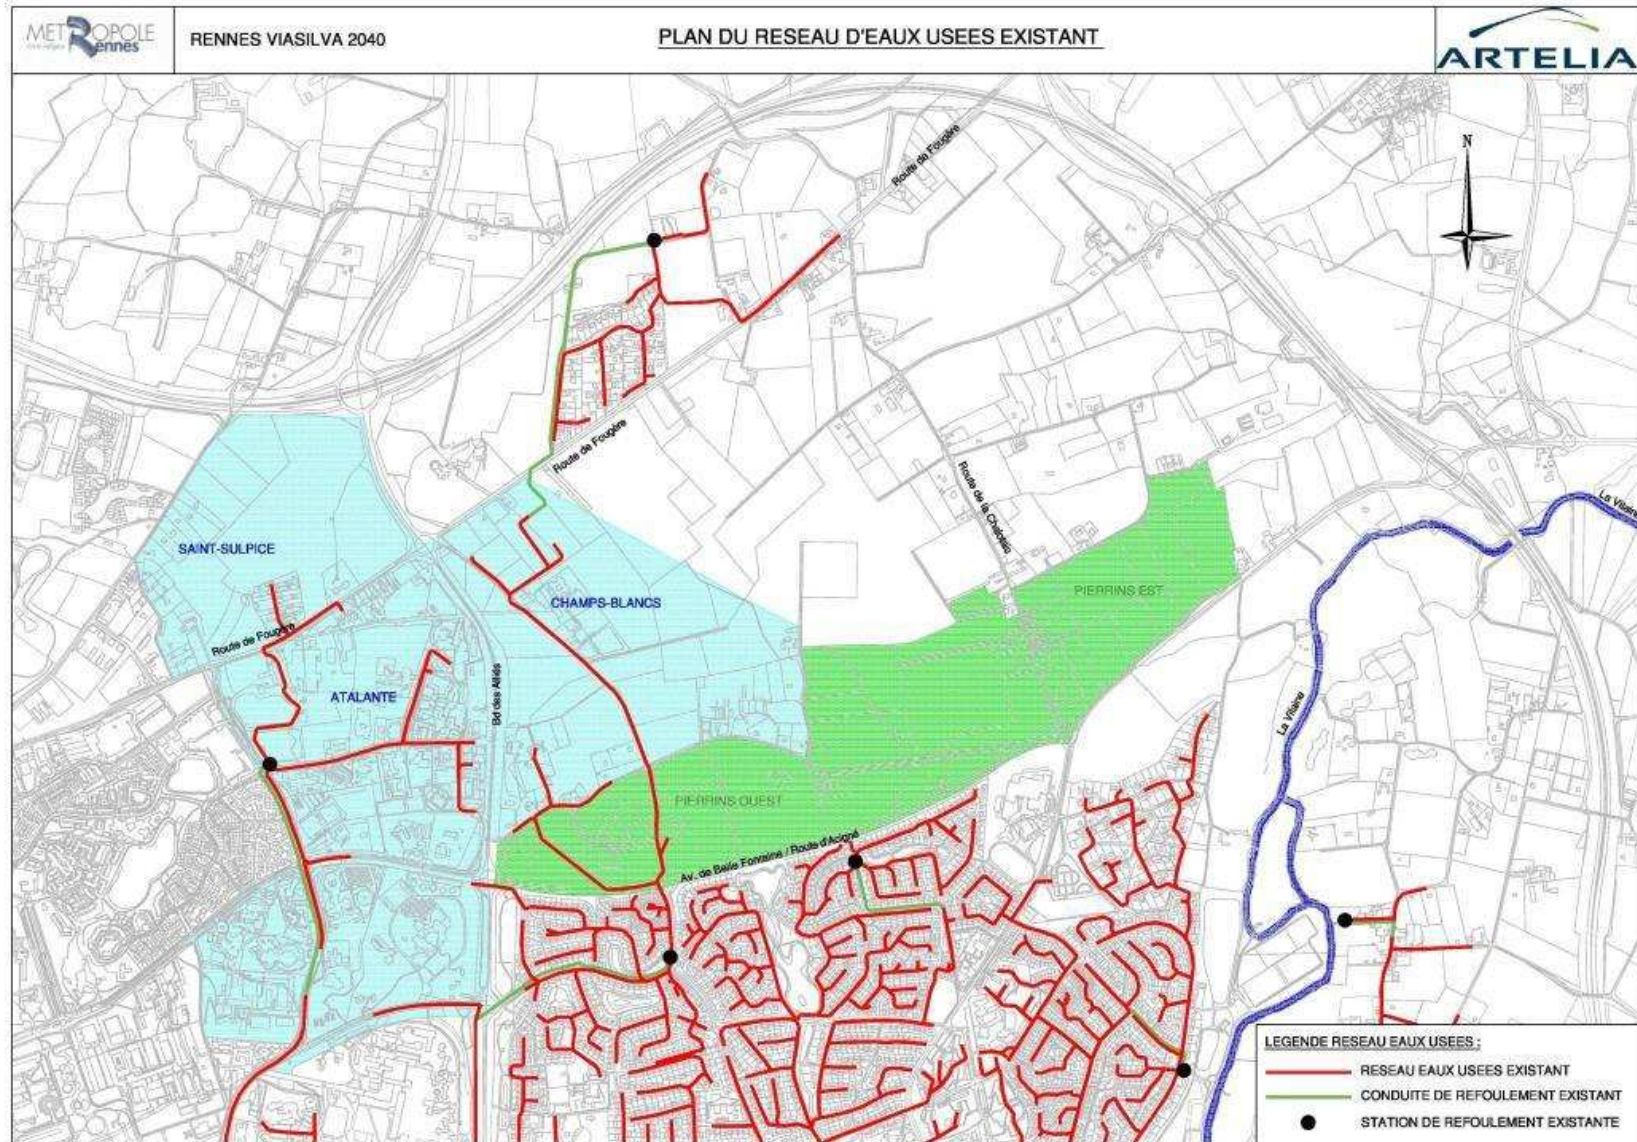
PLAN DU RESEAU D'EAUX USEES (ARTELIA, 2013)
